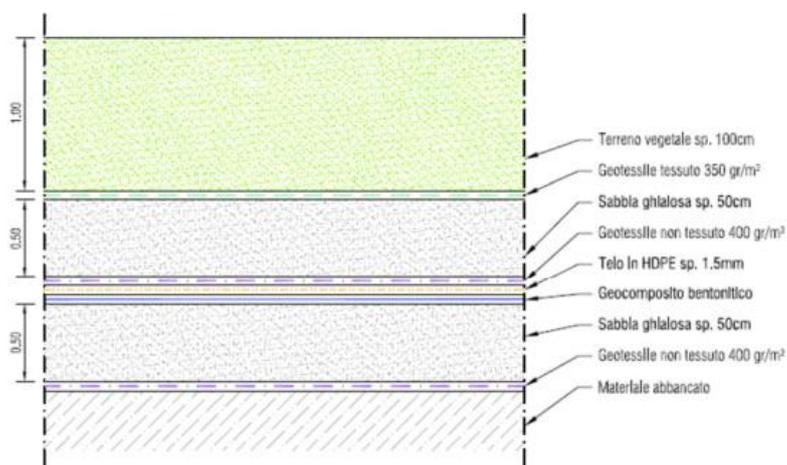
Stralcio progettuale relativo alla stratigrafia del pacchetto di copertura tipo in corrispondenza delle aree subpianeggianti di allocazione con finitura a verde - È presente l'indicazione dei vari strati di geotessili.
